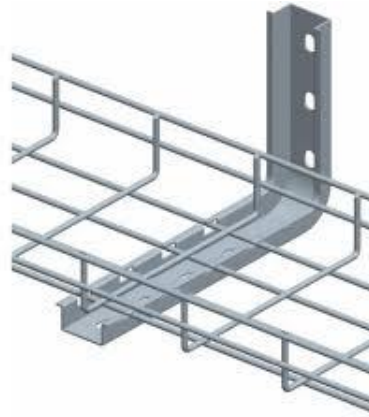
Bandeja cortacable tipo fondo ventilado.
